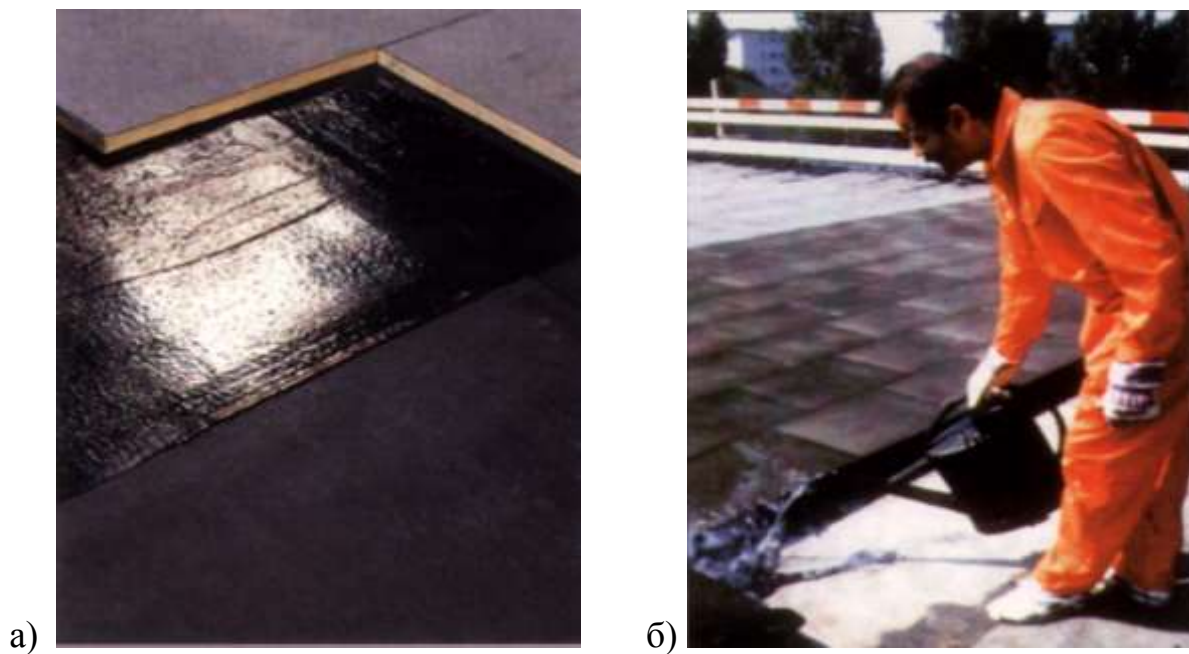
Укладання жорстких плит на основу із залізобетонних плит із приклеюванням мастикою:
